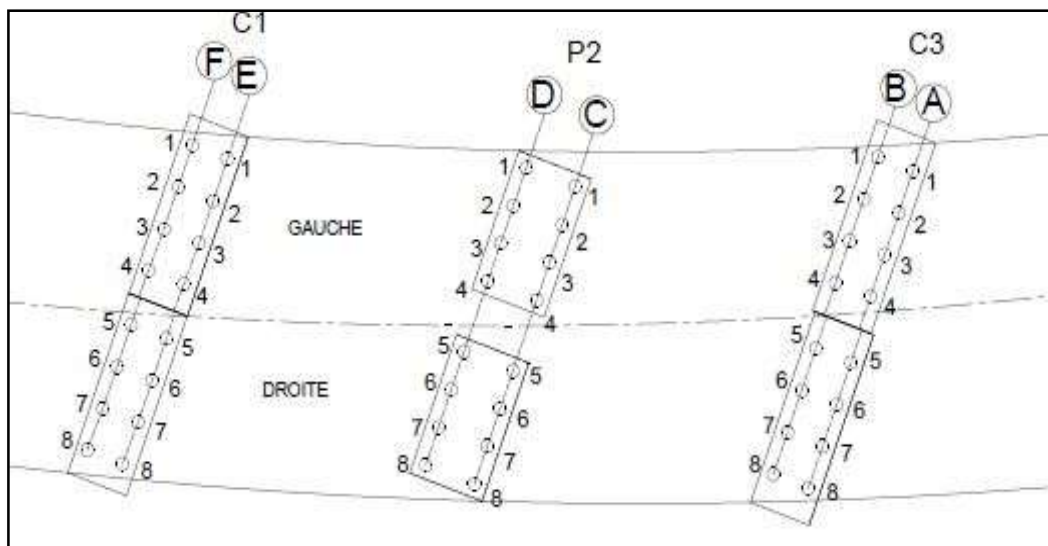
Plan d'implantation des semelles et des pieux(B.E.SEROR)
